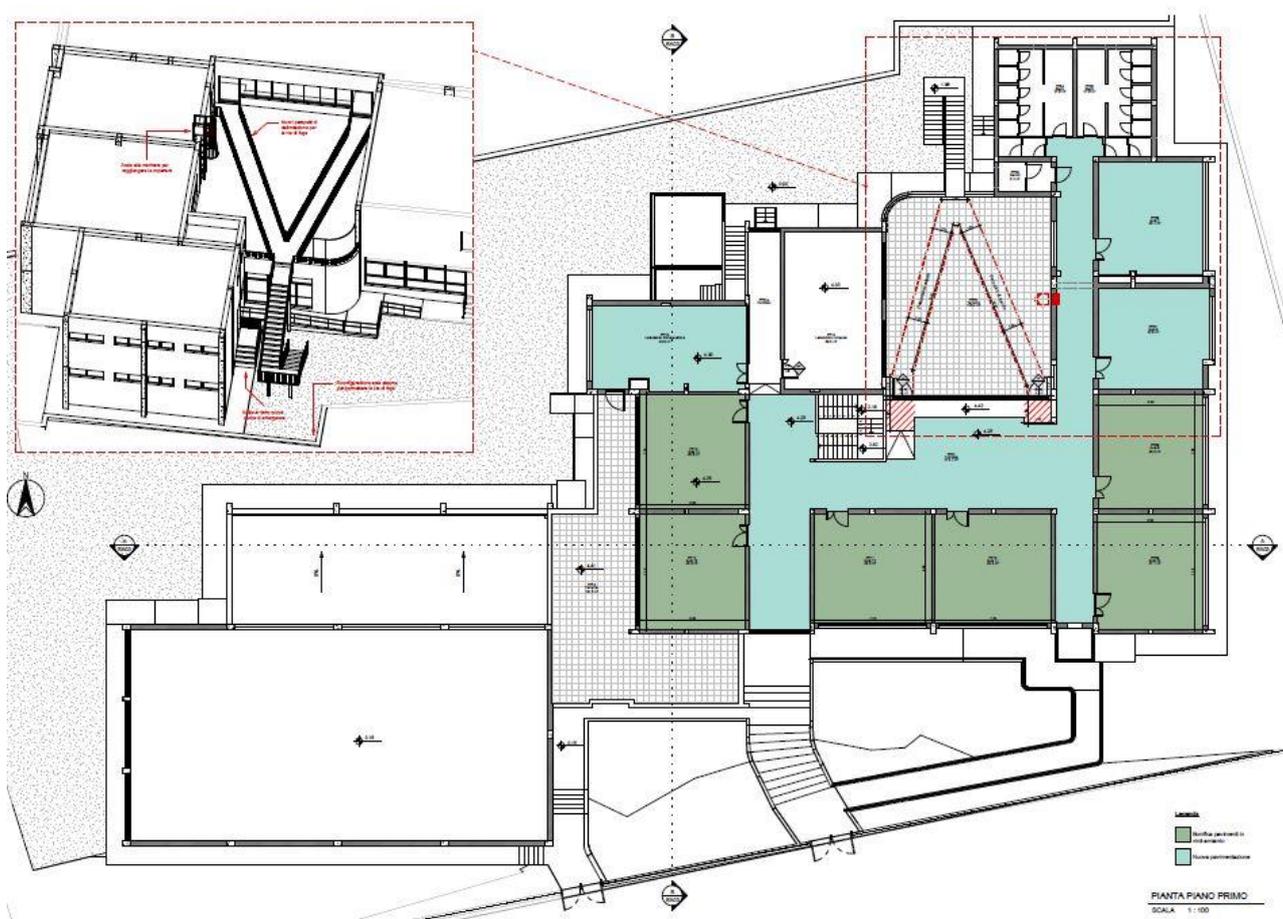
pianta piano terra e primo con l'individuazione in verde scuro degli ambienti con pavimentazione contenente amianto e in verde chiaro le altre pavimentazioni di cui è prevista la sostituzione.
